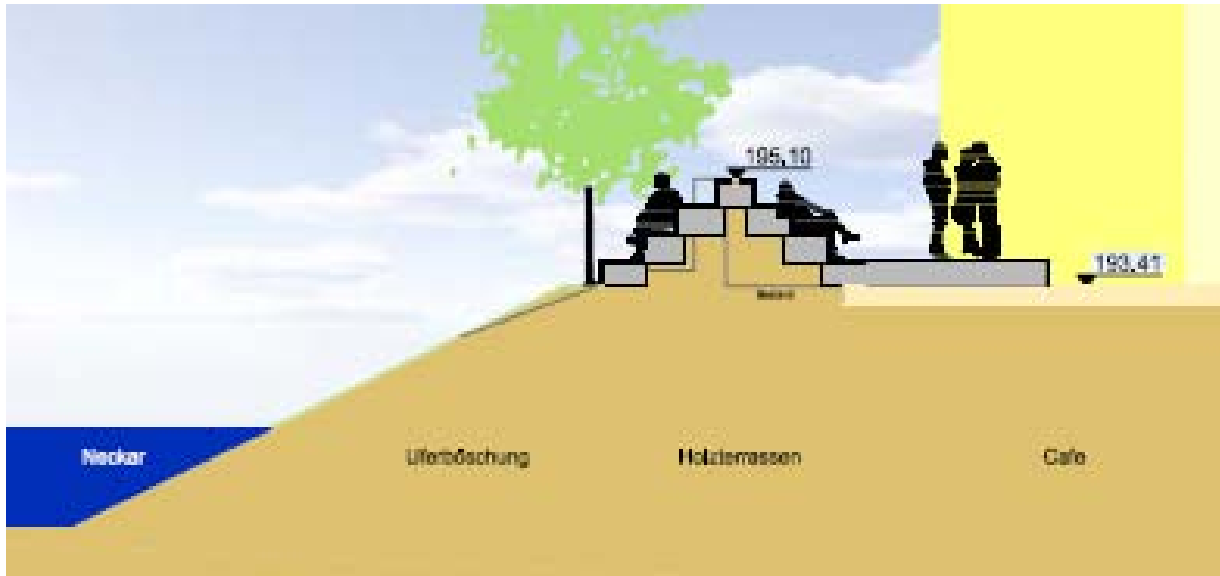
Schnitt der Sitzstufen an der Hochwassermauer (Quelle: Planstatt Senner)
